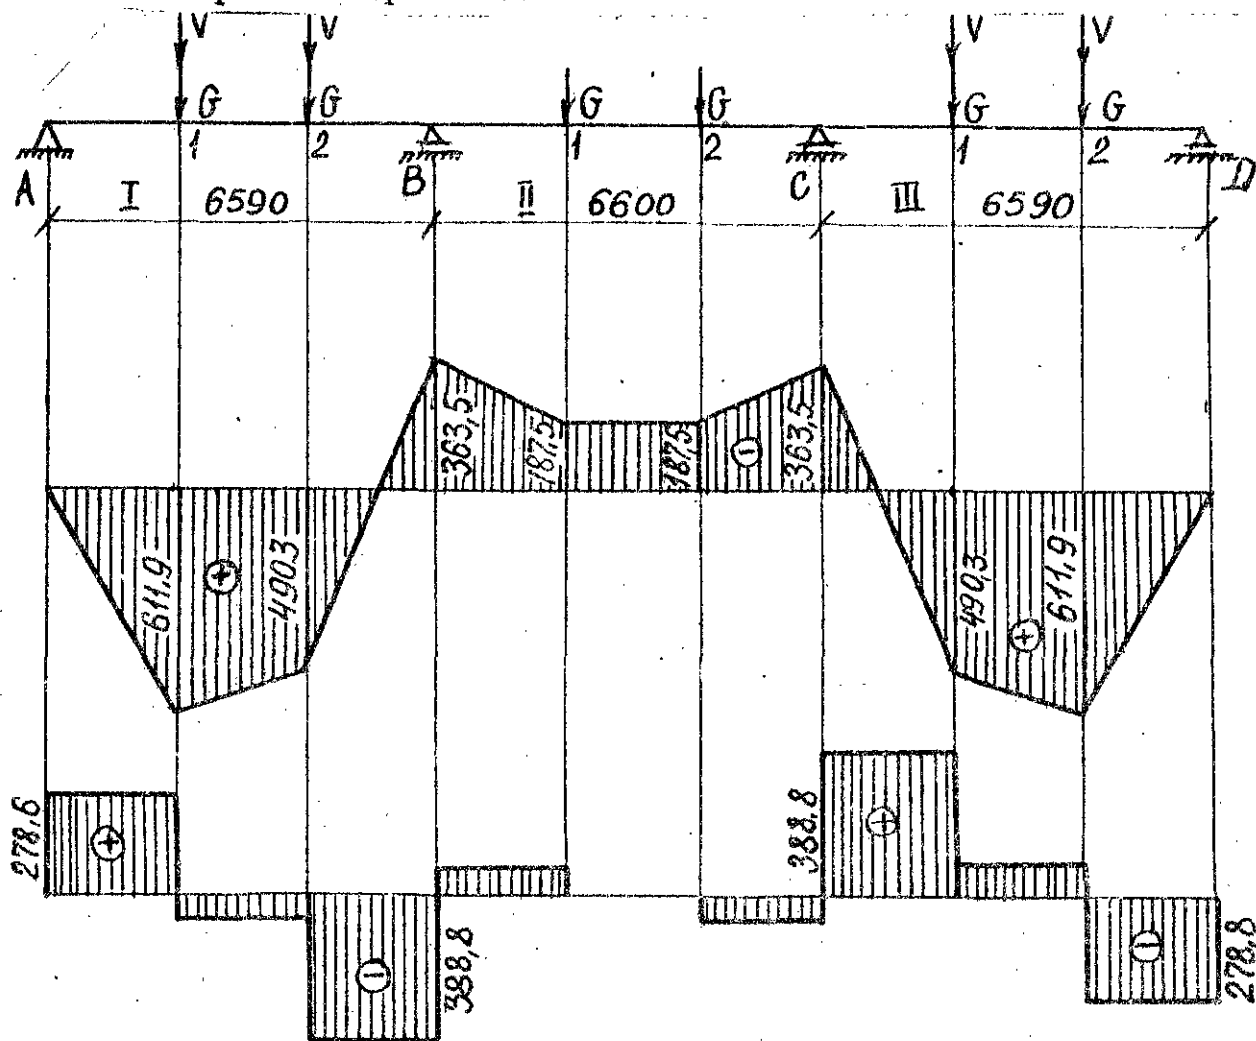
Расчетная схема, эпюры M и Q при I-й комбинации нагрузок
